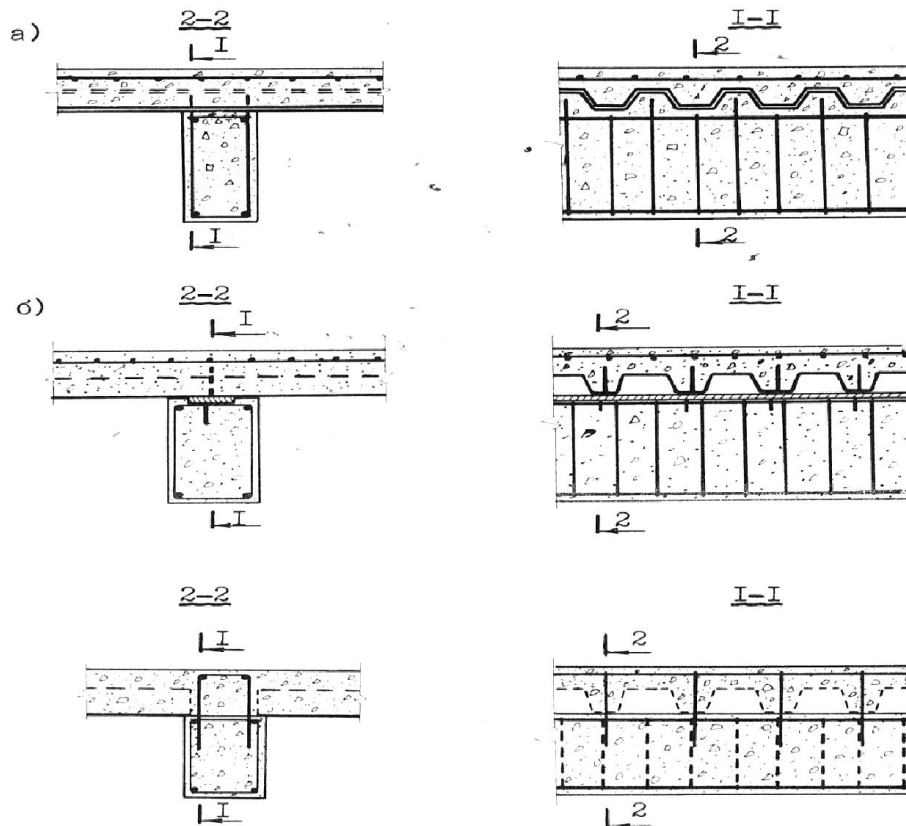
Конструкции перекрытий, возводимых по железобетонным прогонам
